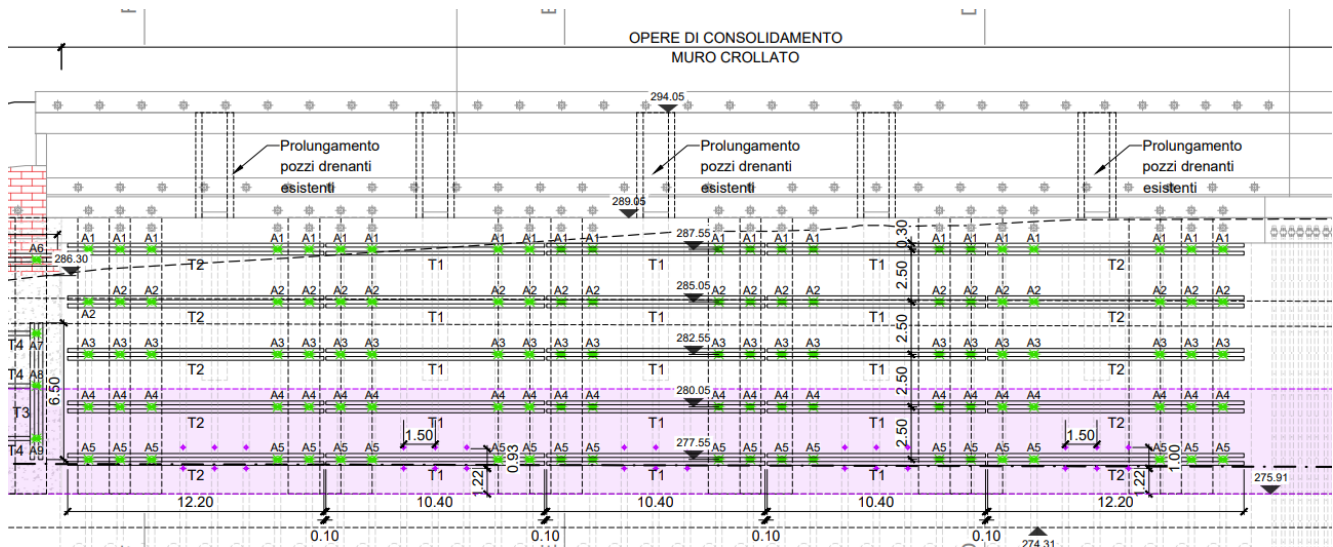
Stralcio del prospetto degli interventi sul muro crollato consolidato.
